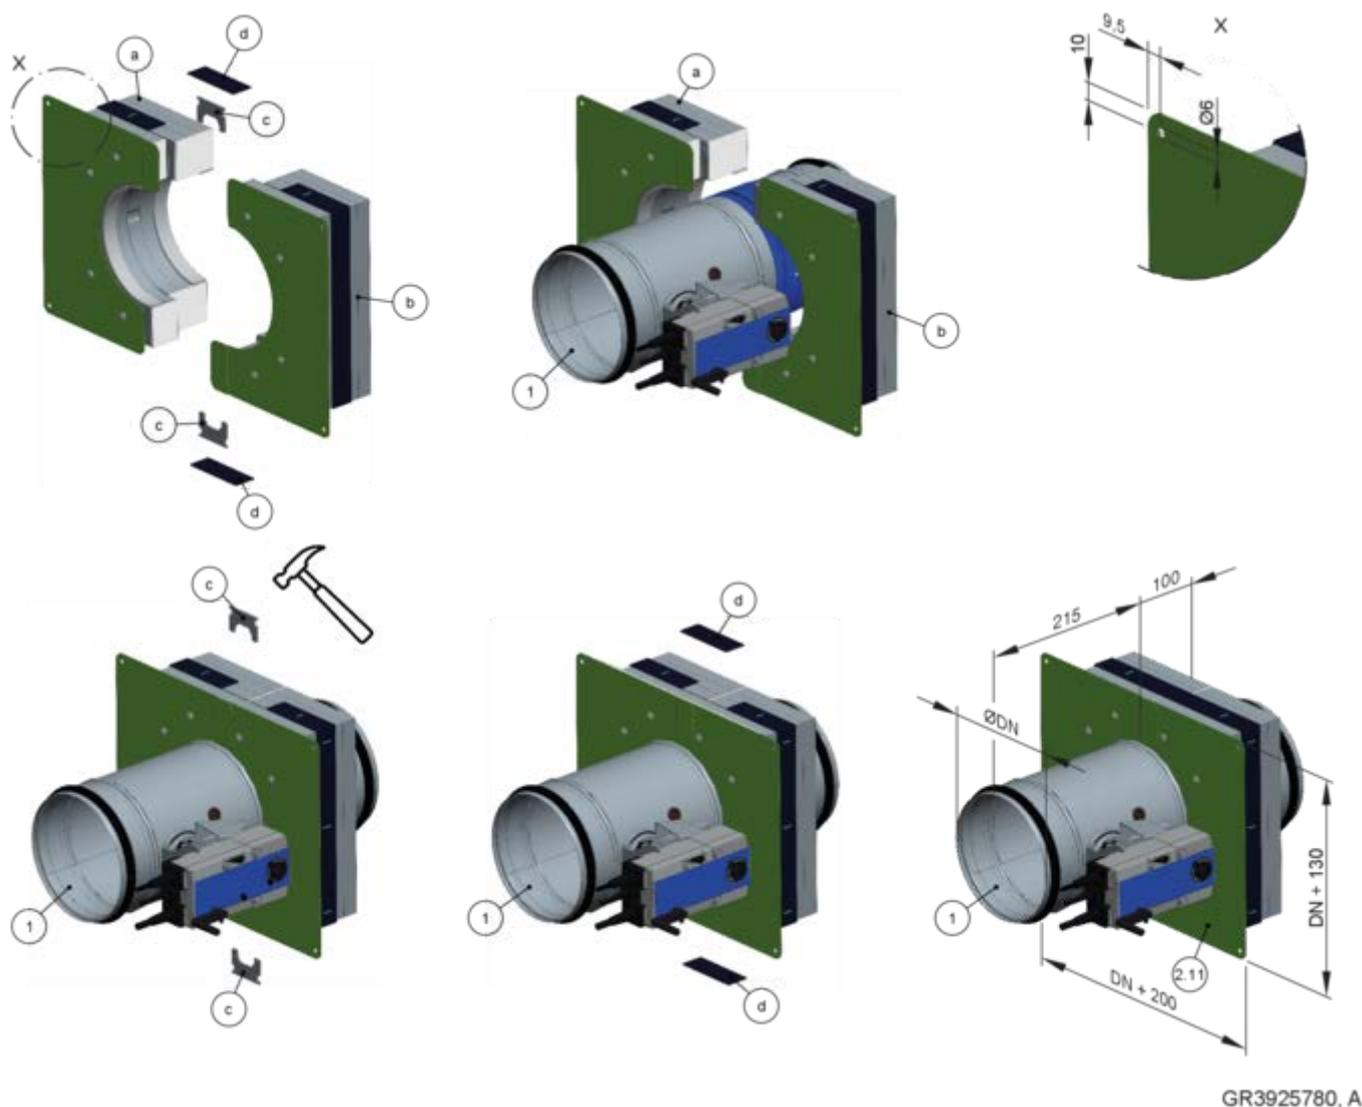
Fourniture et installation du kit de montage TQ2 pour un montage à sec sans mortier
